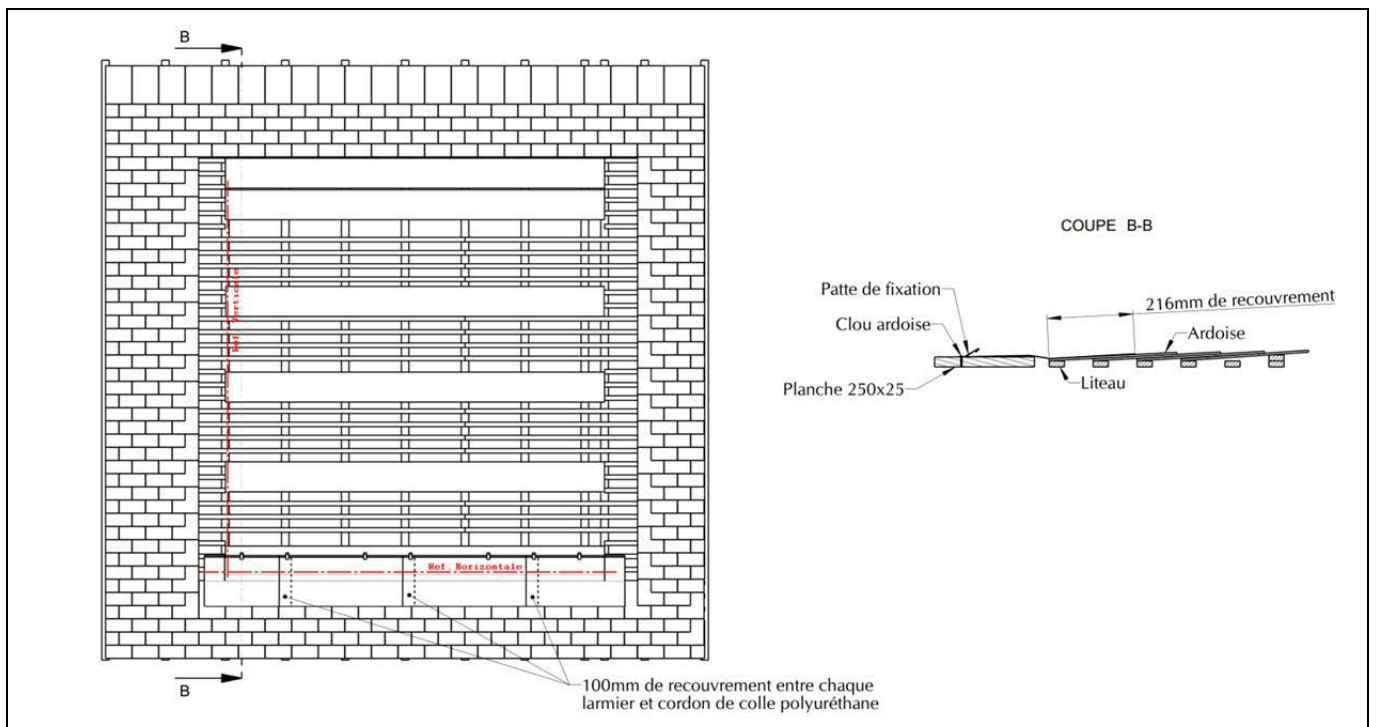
Pose des larmiers inférieurs pour installation ardoise
